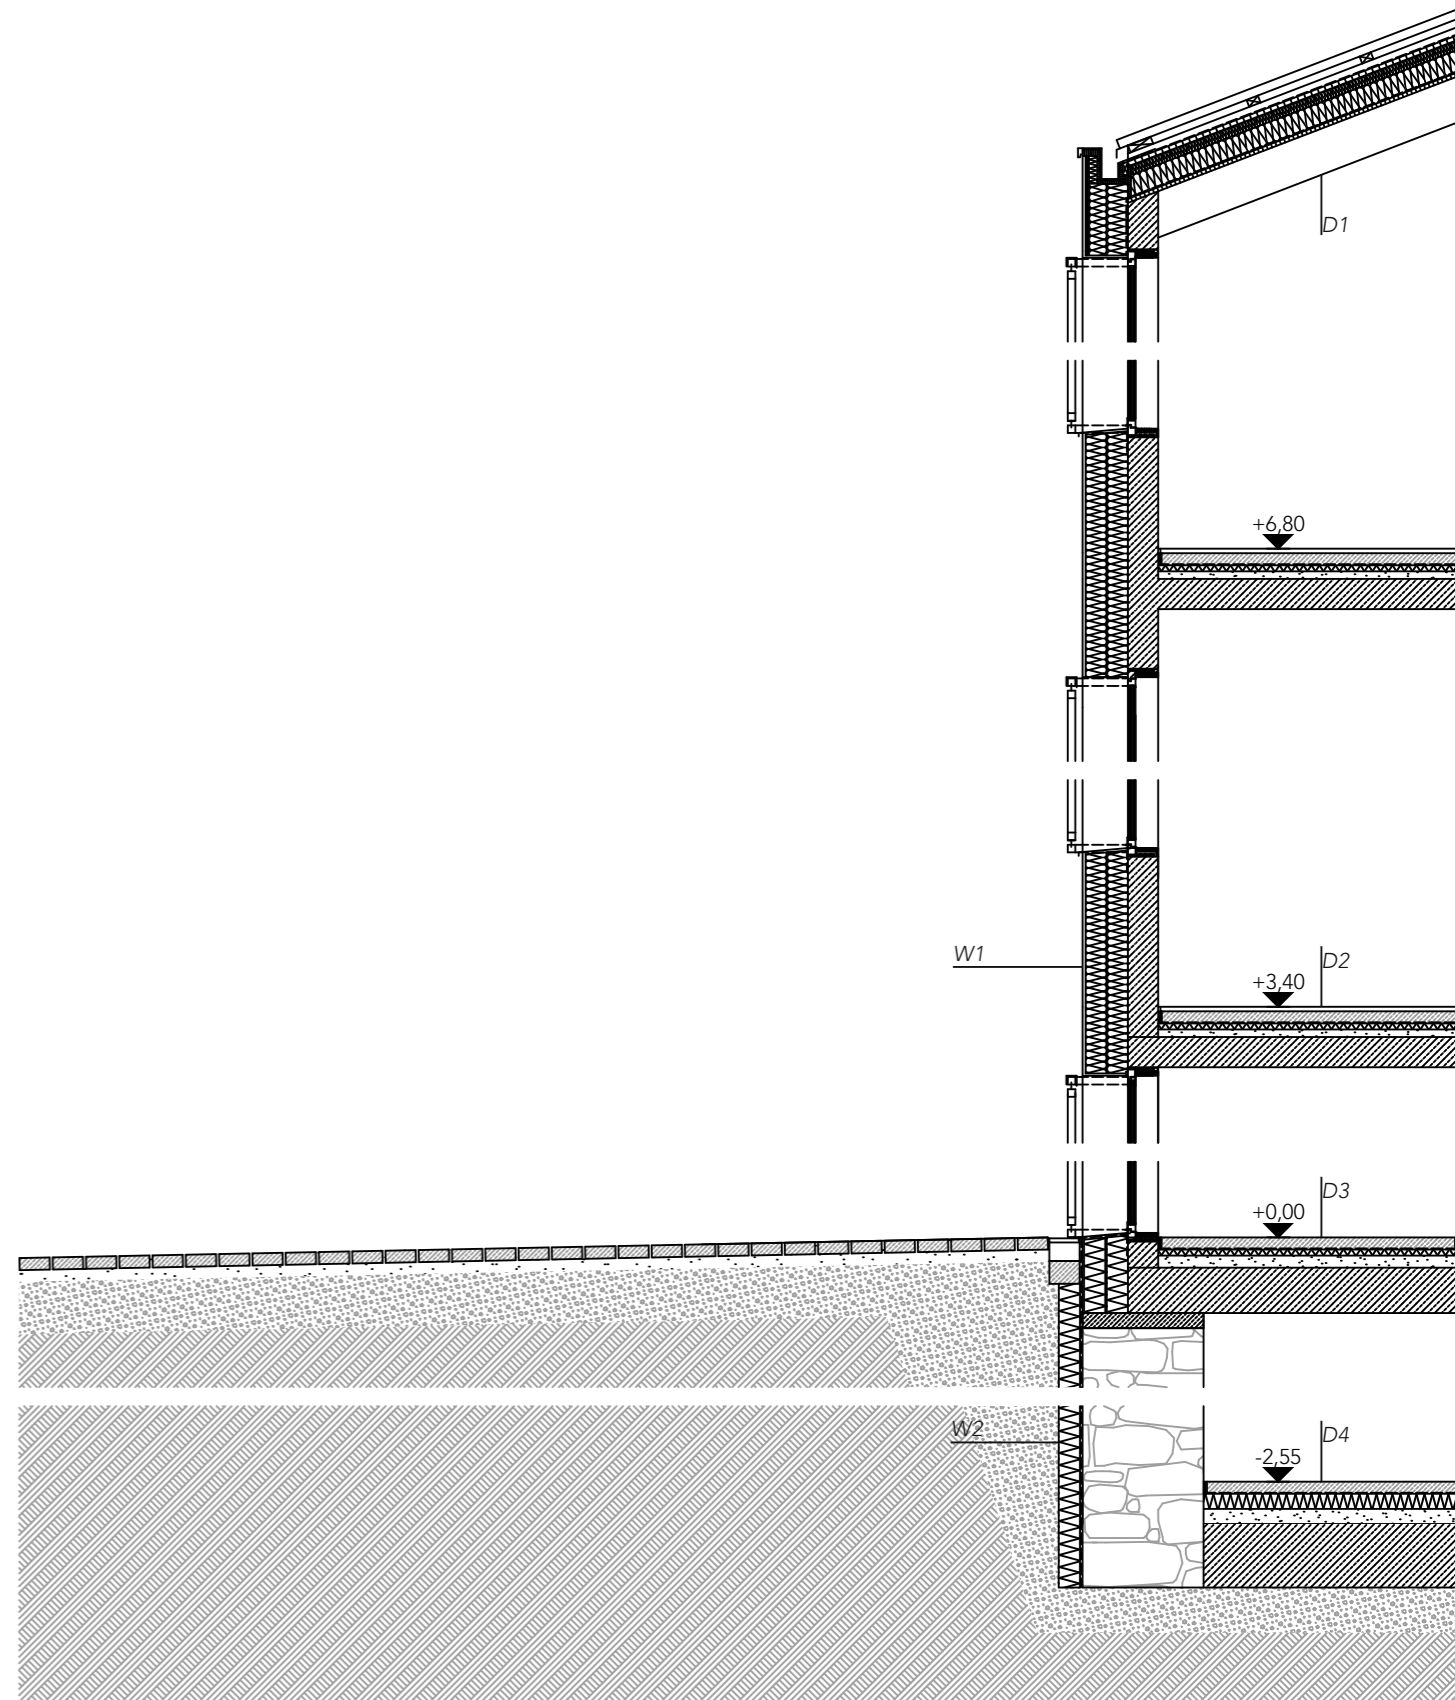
Fassadenschnitt Hauptstraße M 1:50
